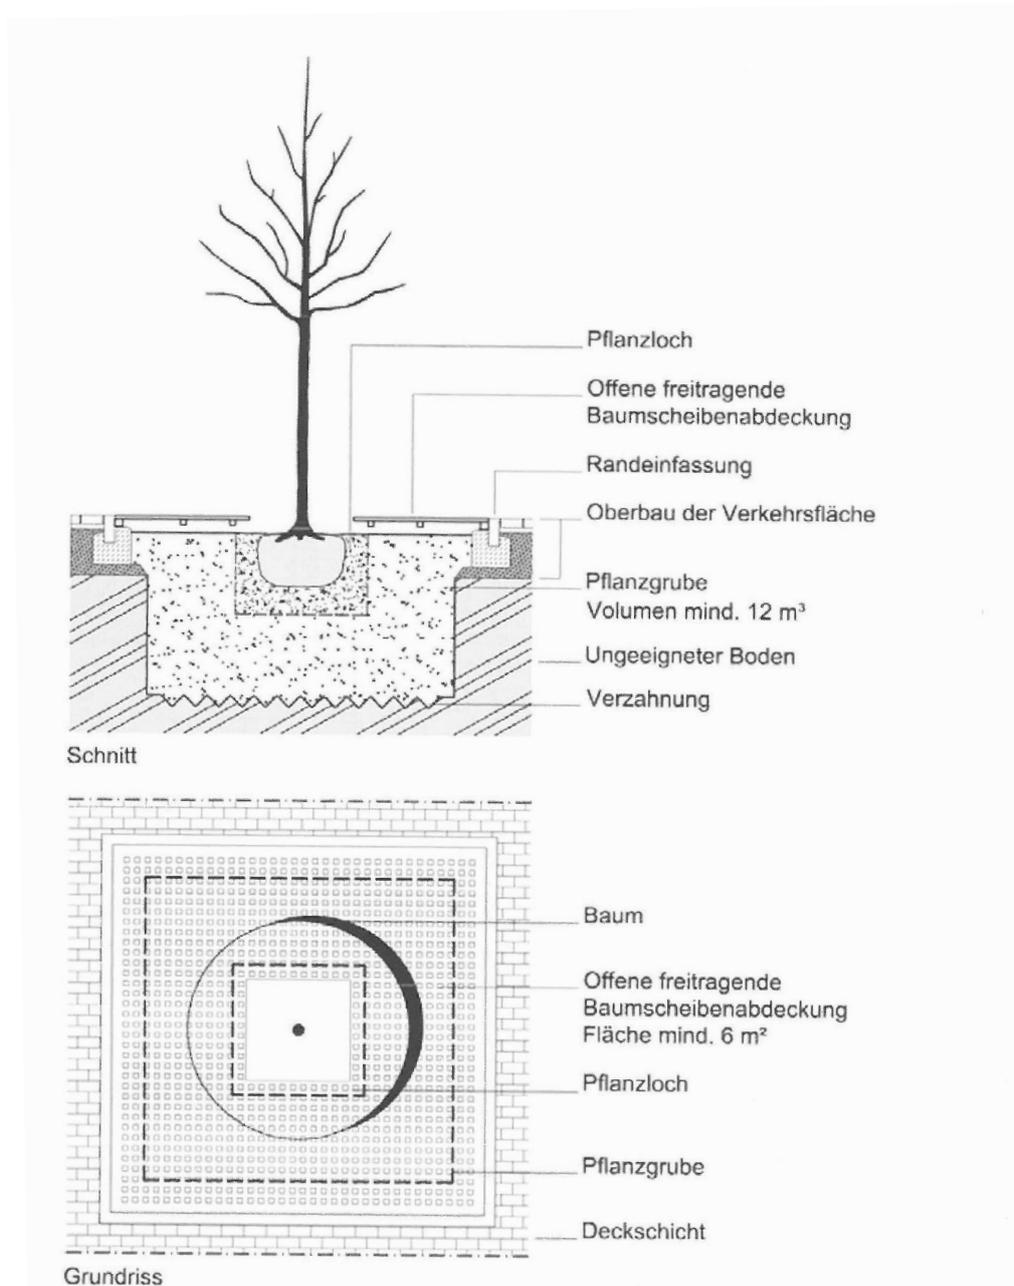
Darstellung einer Pflanzgrube sowie des Grundrisses einer Baumscheibe (FLL 2015, S. 26)
